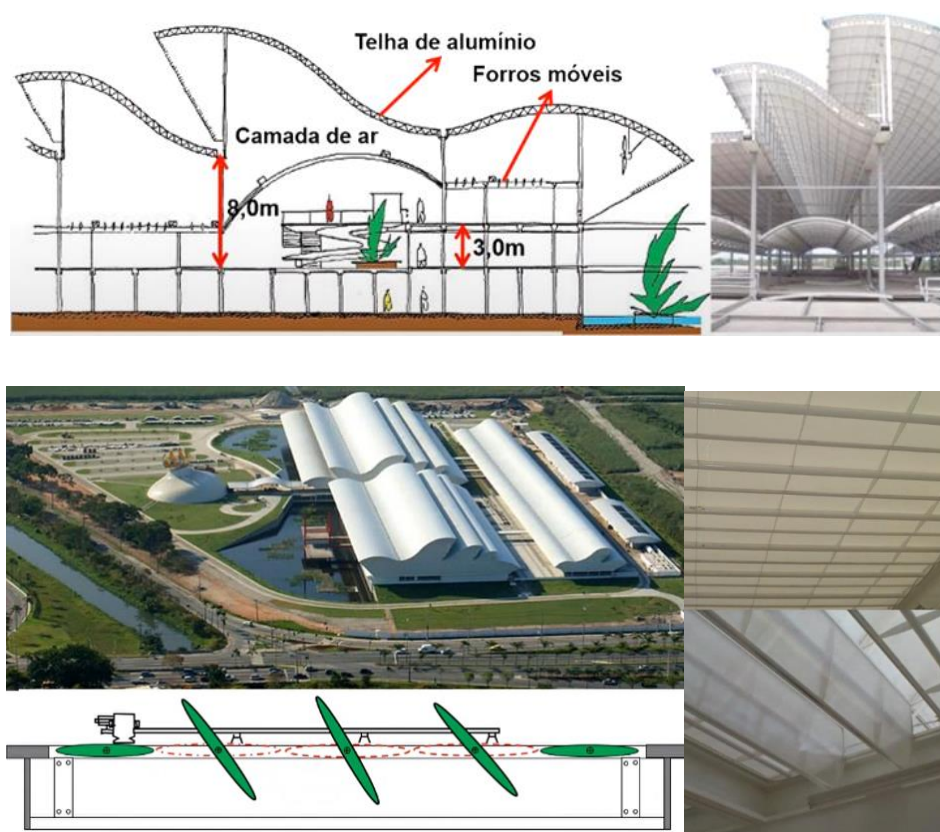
Cobertura Sarah Rio de Janeiro croqui Lelé com dimensões e legendas editadas pela autora. Fonte : acervo Rede Sarah. Fotos e esquema de forros móveis: Marieli Lukiantchuki
